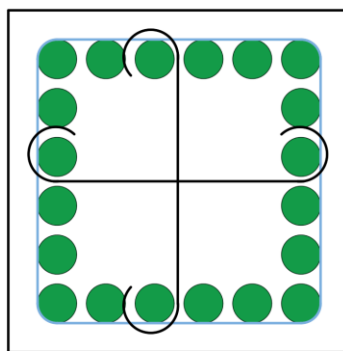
Sección Transversal de una Columna Confinada. Fuente: Nicolás Pozo
